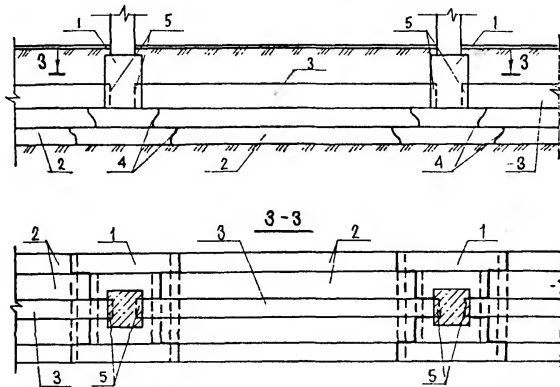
Устройство перемычек в уровне подошвы фундаментов совместно с диафрагмами жесткости
